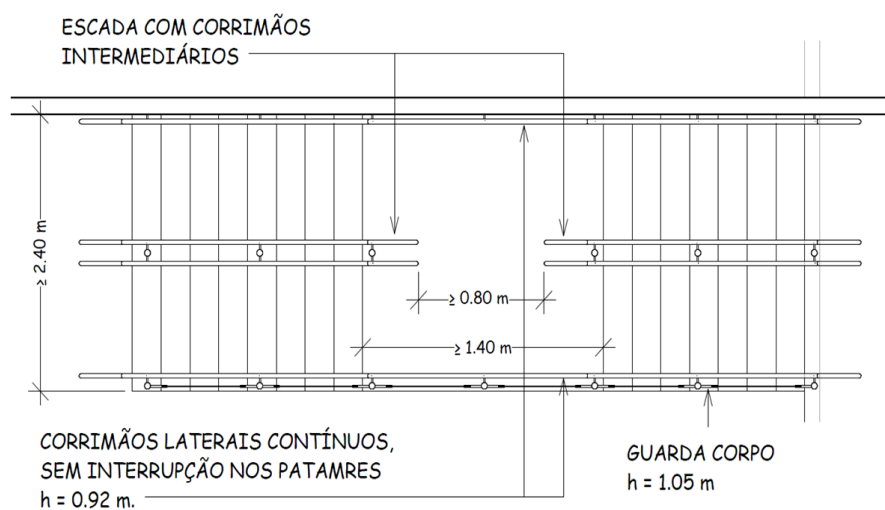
A - Escada com corrimãos intermediários (planta baixa)
